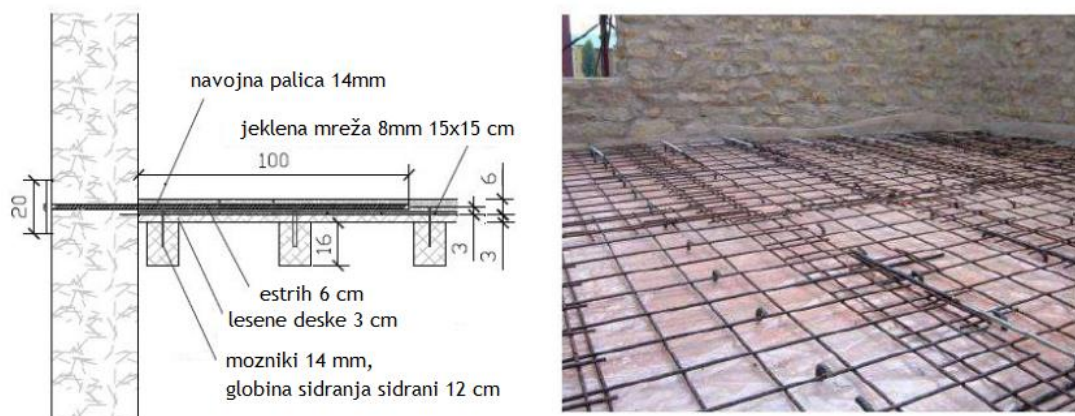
Shema sidranja armirano betonske plošče v obstoječe zidove [6]
